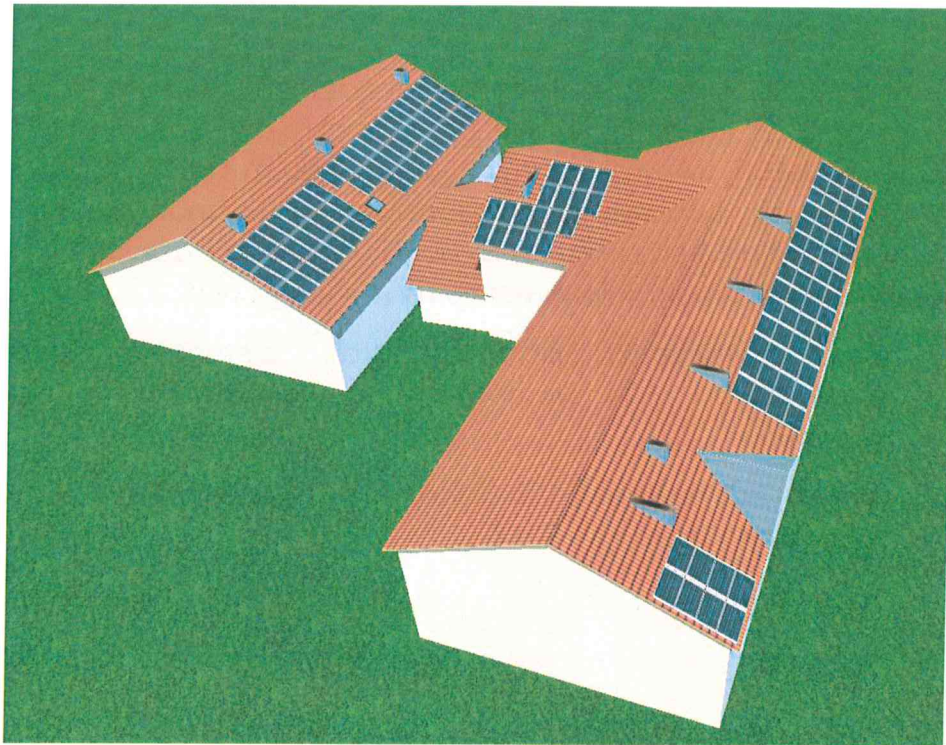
Konstrukcja wsporcza modułów – system montażu c blachodachówki, układ pionowy
